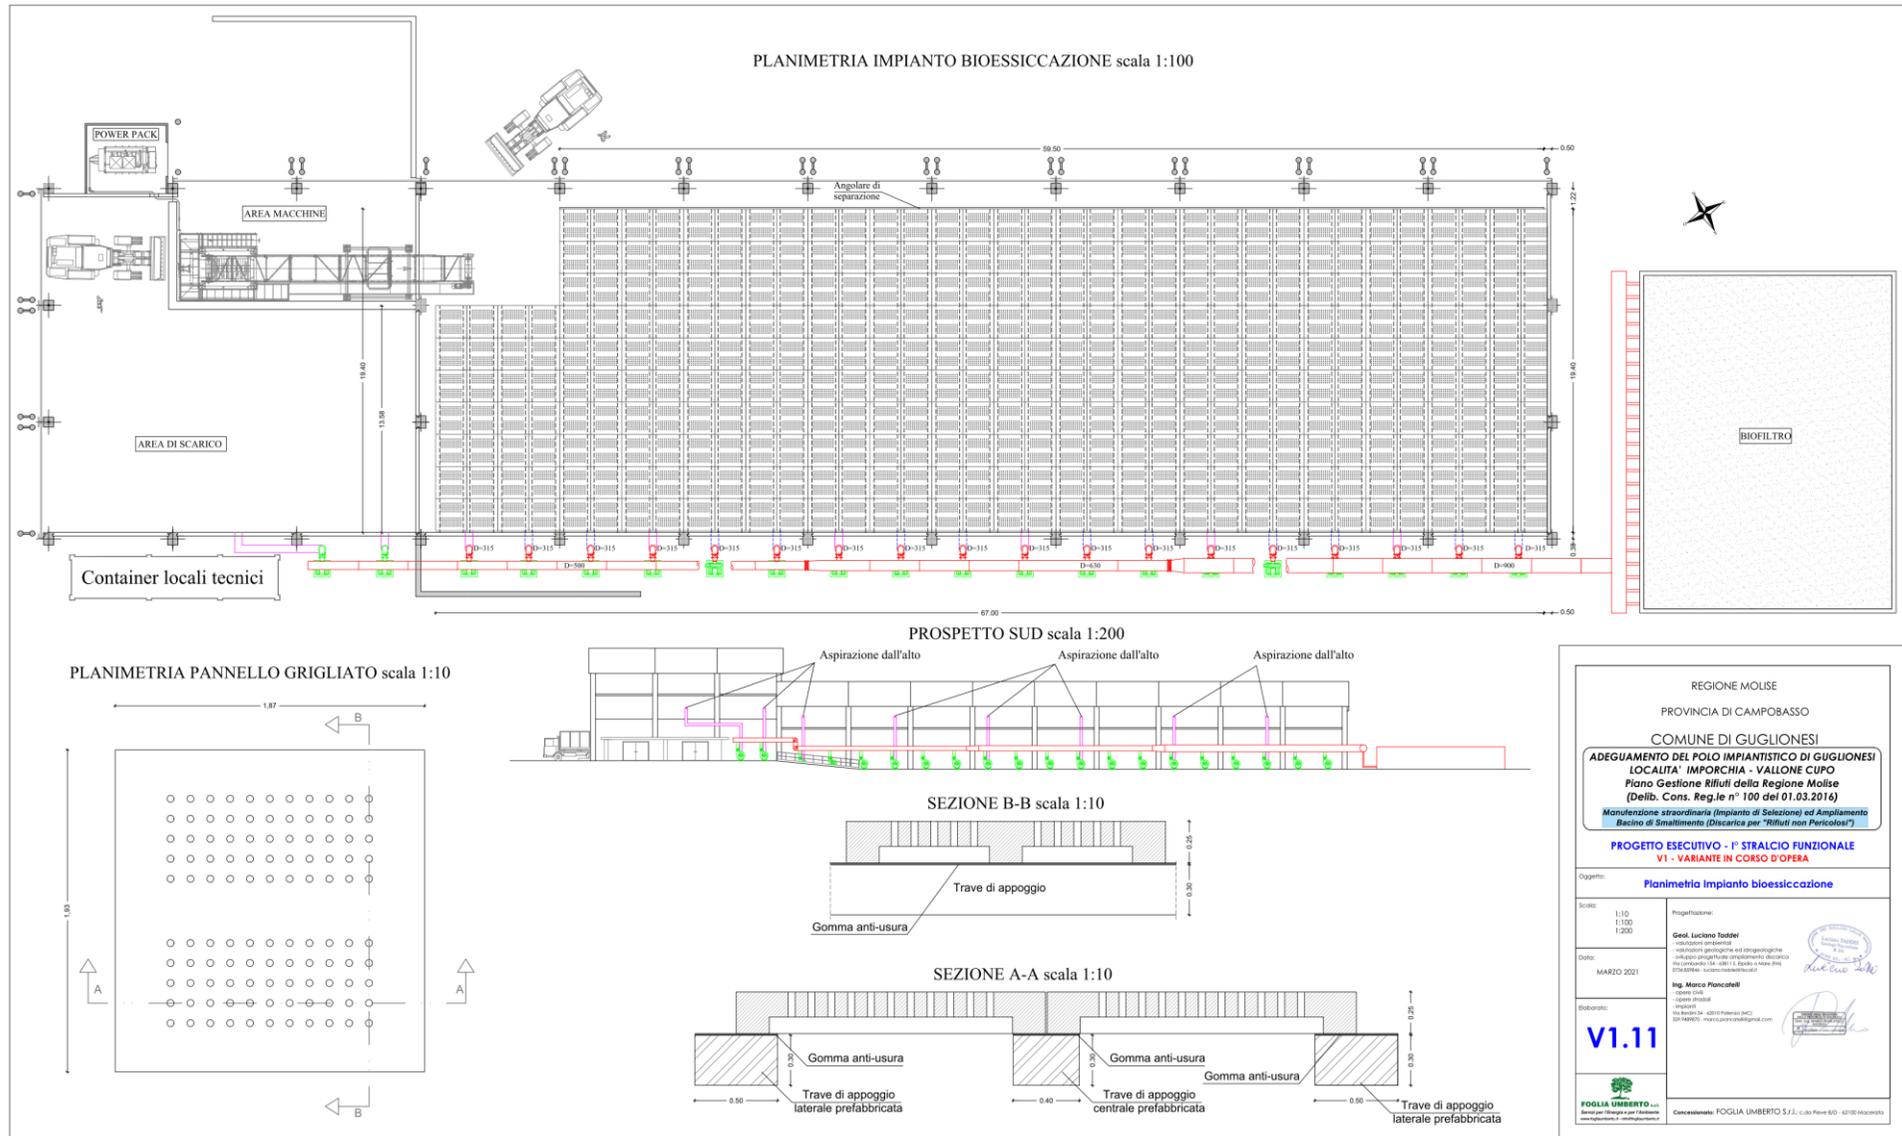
planimetria impianto di bioessiccazione: assetto "post operam"
